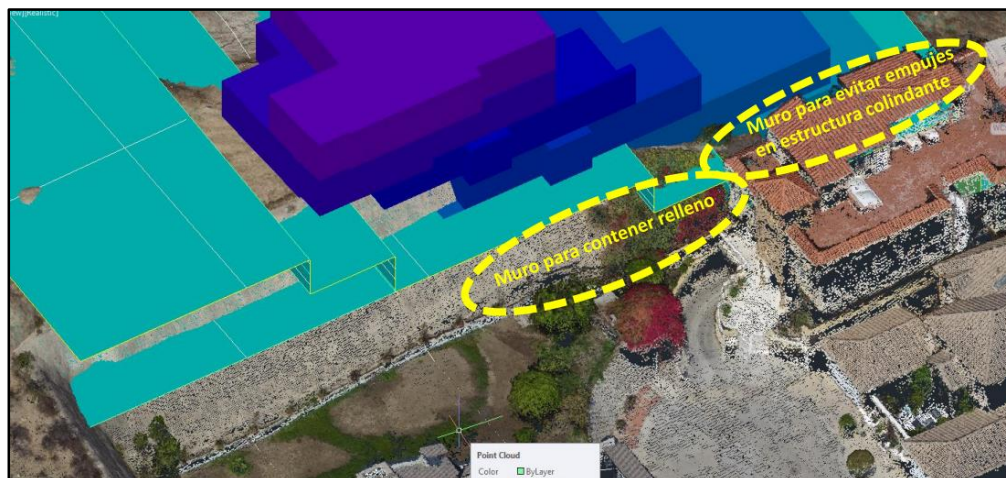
Detalles del muro para contener relleno y evitar empujes en estructura colindante
